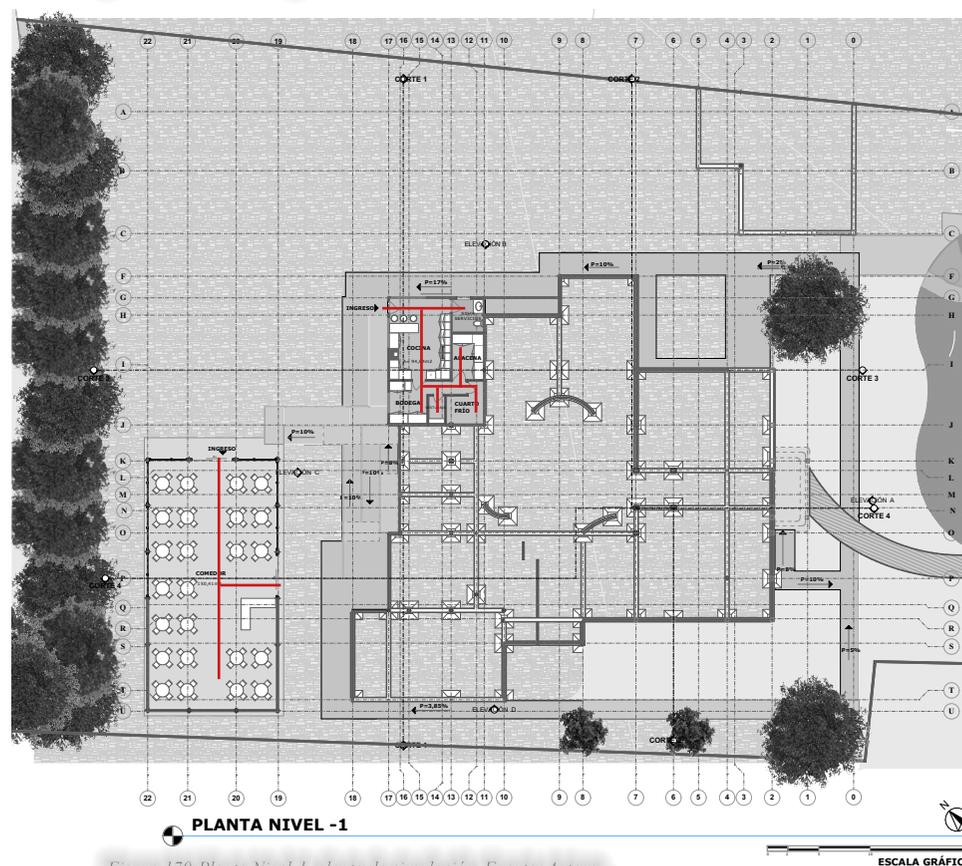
Planta Nivel-1, planta de circulación. Fuente: Autora.
